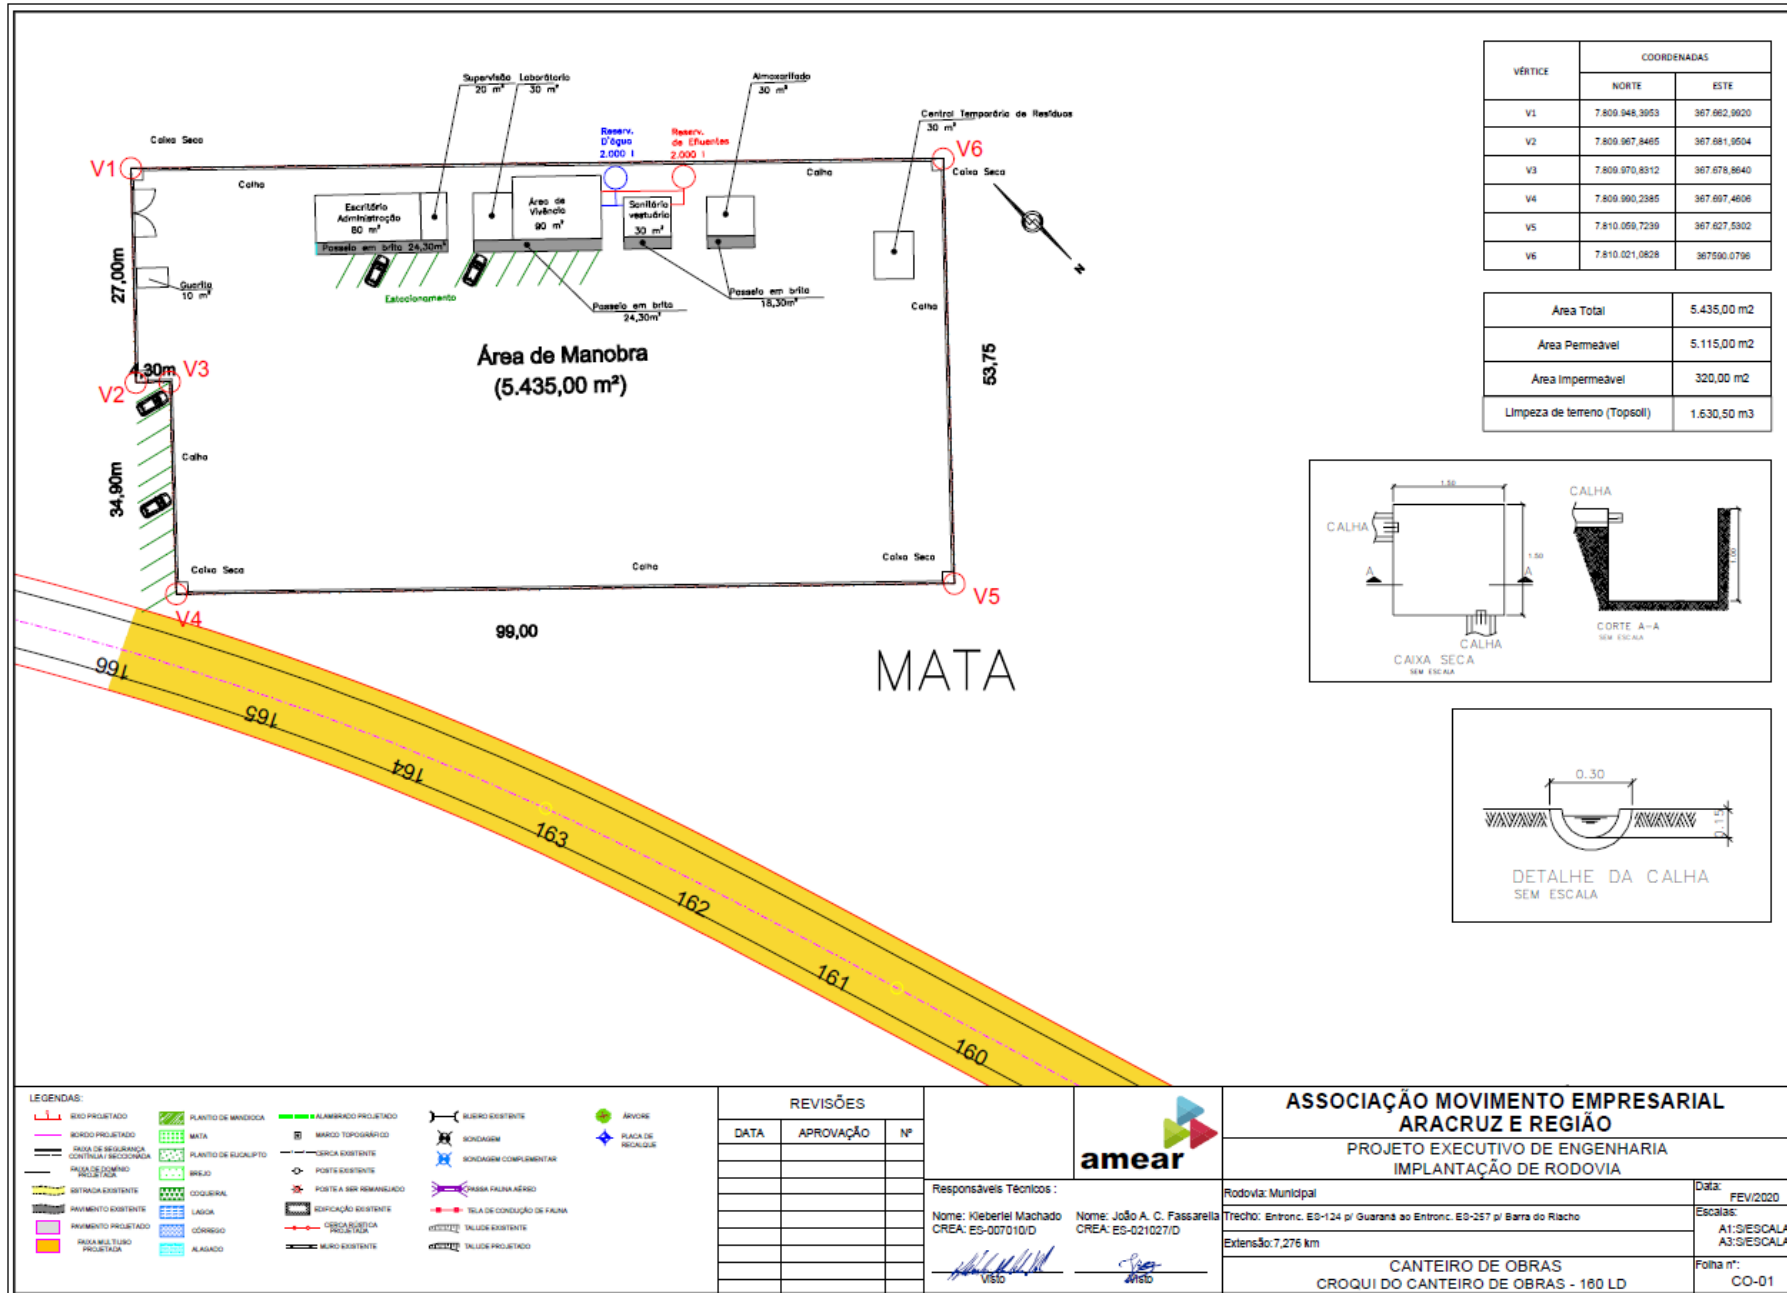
Desenho esquemático demonstrando as estruturas presentes no canteiro de obras do trecho Norte e sua disposição
